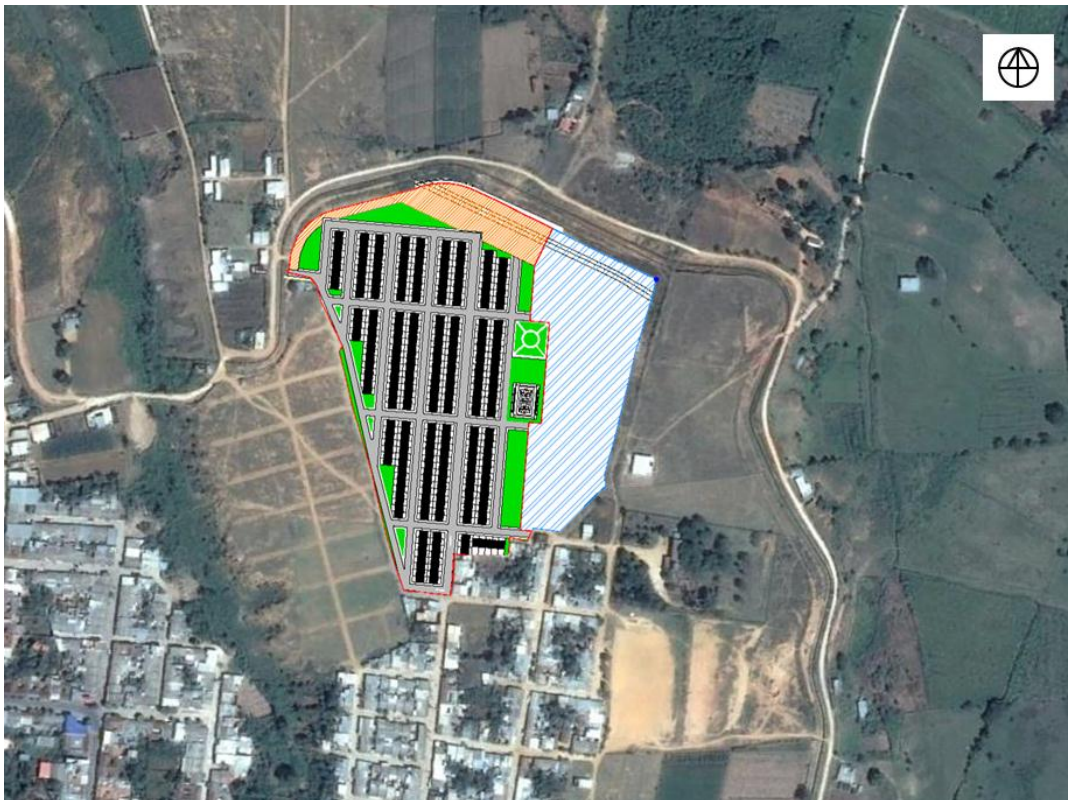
Ubicación en el territorio, Abrego. Autoría Propia.
